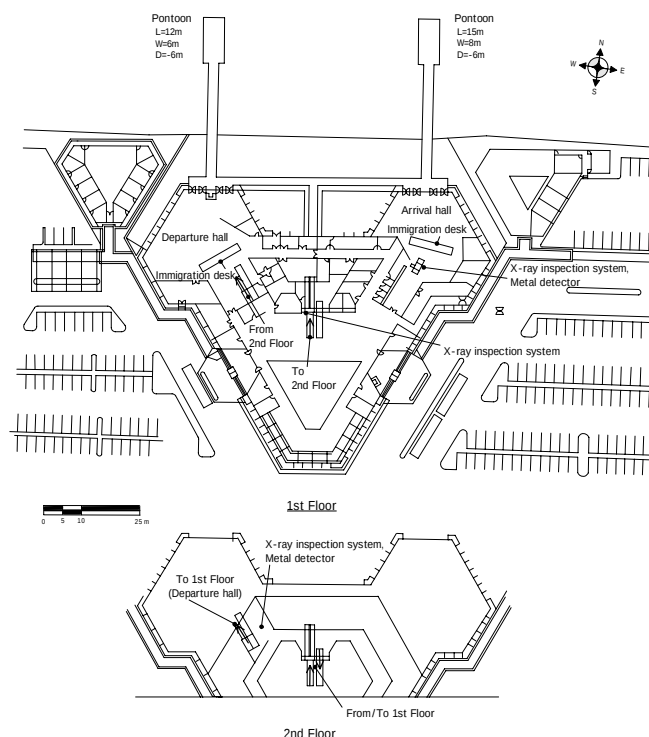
バタムセンター埠頭旅客ターミナル平面図
